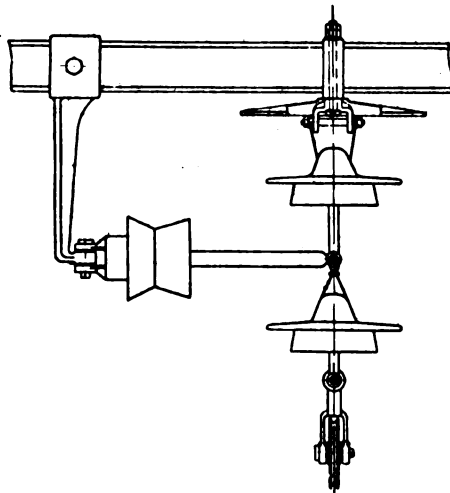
Suspension du câble porteur pour compenser automatiquement la tension du fil de contact.
